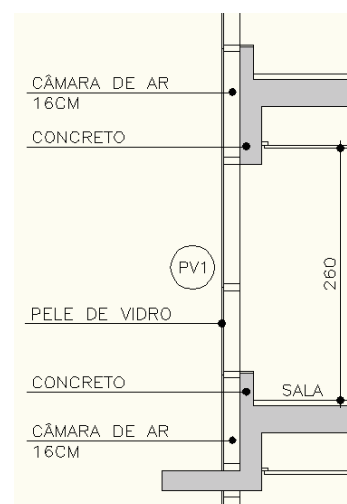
Corte transversal da fachada em vidro (adaptado de arquivo da construtora).
